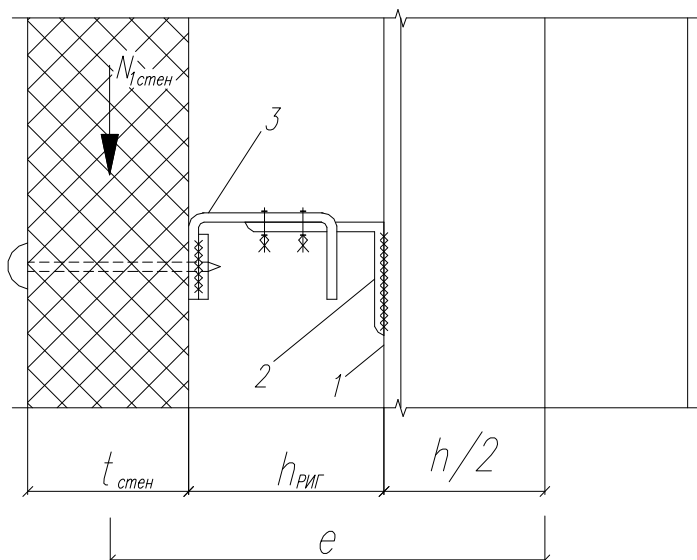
Крепление стеновой панели к продольному ригелю при вертикальной разрезке стен
